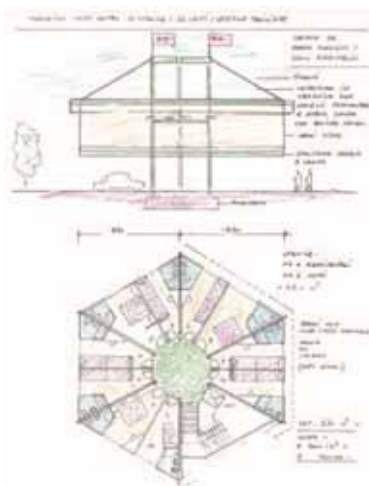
Willi Ramstein. Hotel prefabricado de acero y madera. años 2000 (www. matermeeting.it)
